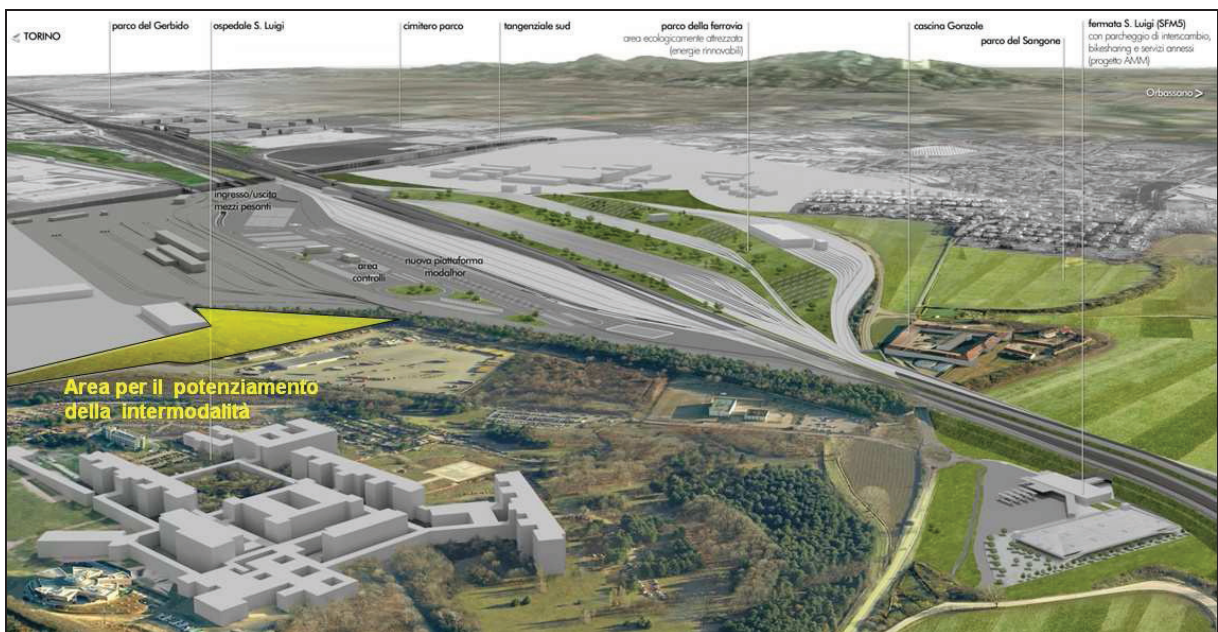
Lo scalo di Orbassano: ricostruzione prospettica con vista da nord-ovest
